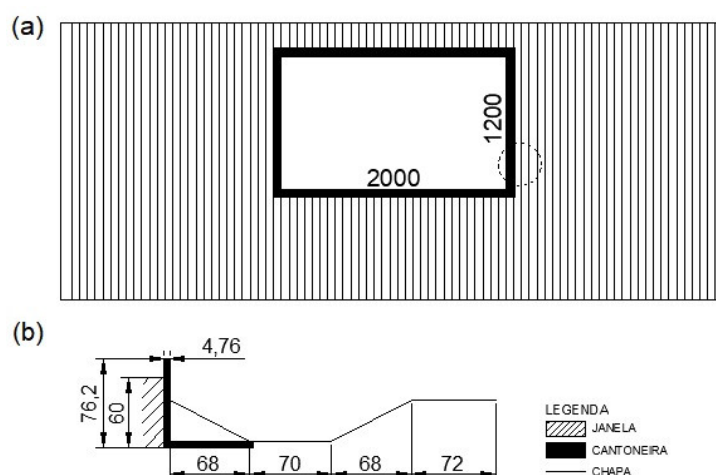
Parede lateral do modelo C-1JC: (a) Vista frontal e (b) vista em planta da área tracejada
